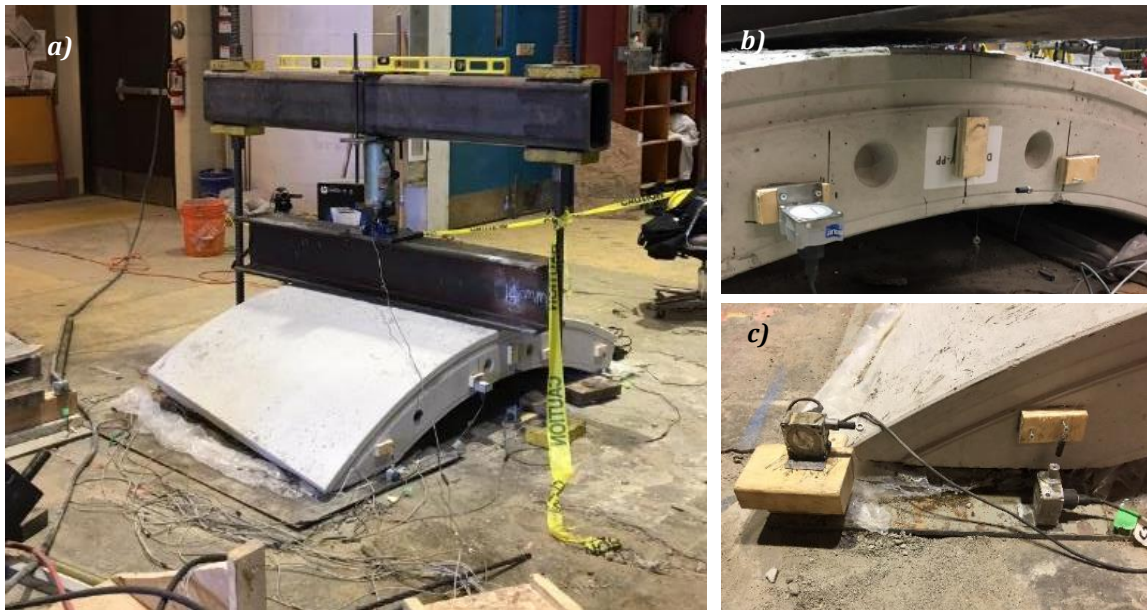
Configuración del ensayo a). LVDT colocados con la finalidad de medir el ancho de fisura debida al ensayo a flexión b). Detalle de la zona de los apoyos c).
